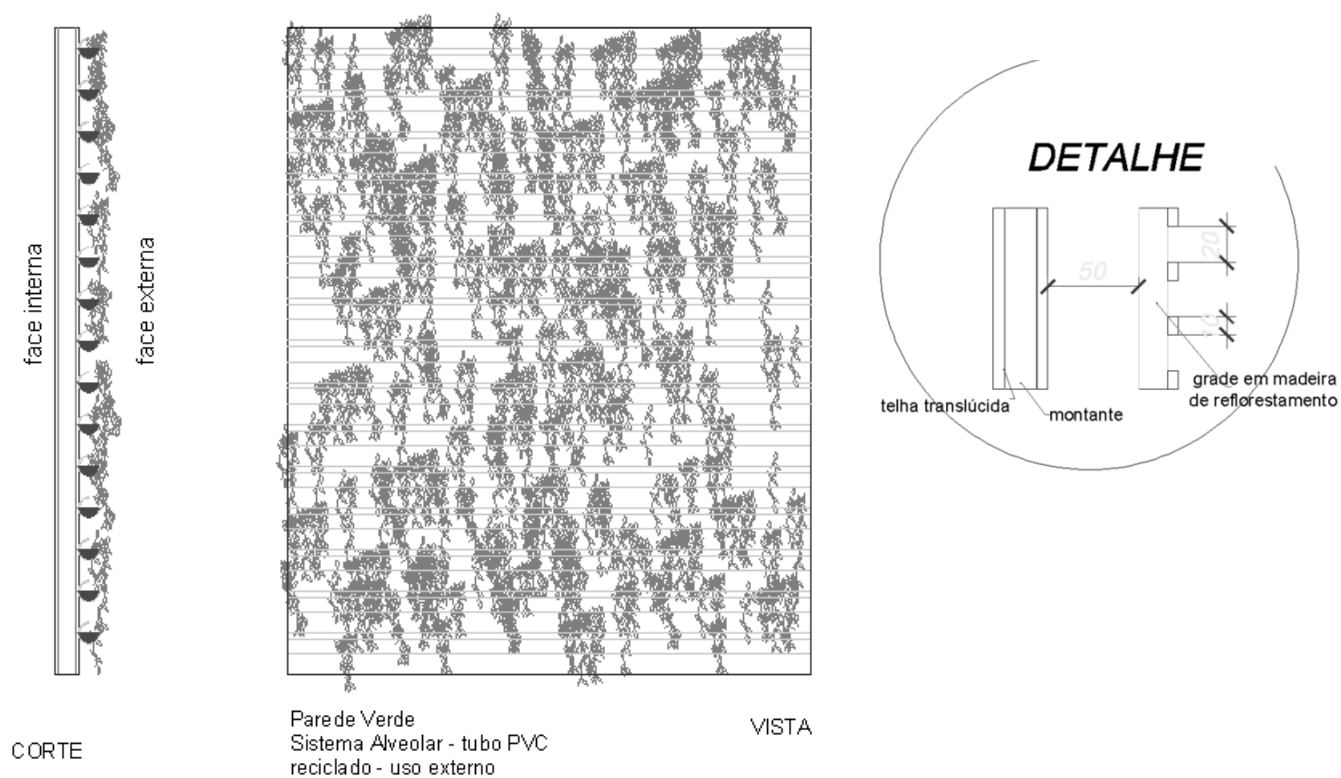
Parede verde em sistema alveolar com tubo de PVC
